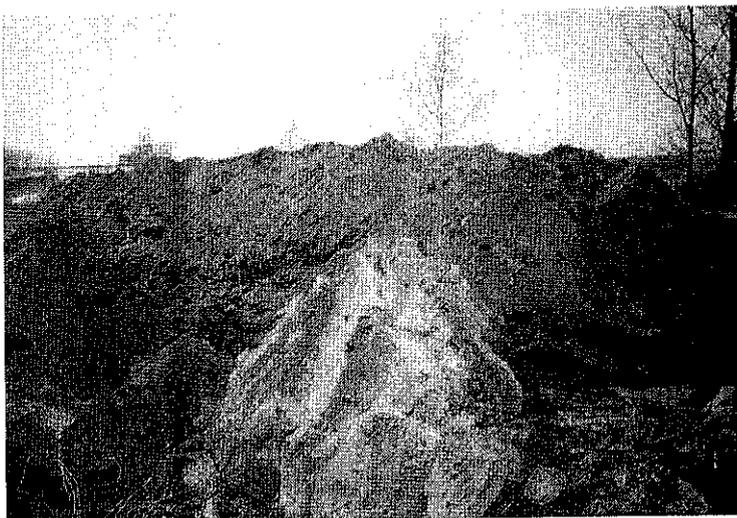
Angefallener Bodenaushub beim Rückbau LFA, südlich Baugrube gelagert
